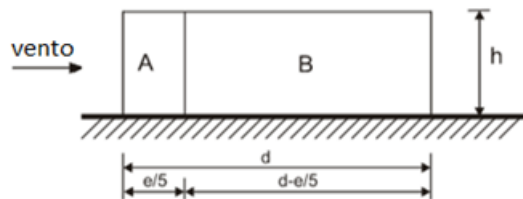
Zoneamento de coeficientes em paredes verticais Norte-Sul Sul (adaptado de (NP 1991-1-4 /7.2.2) [13])
